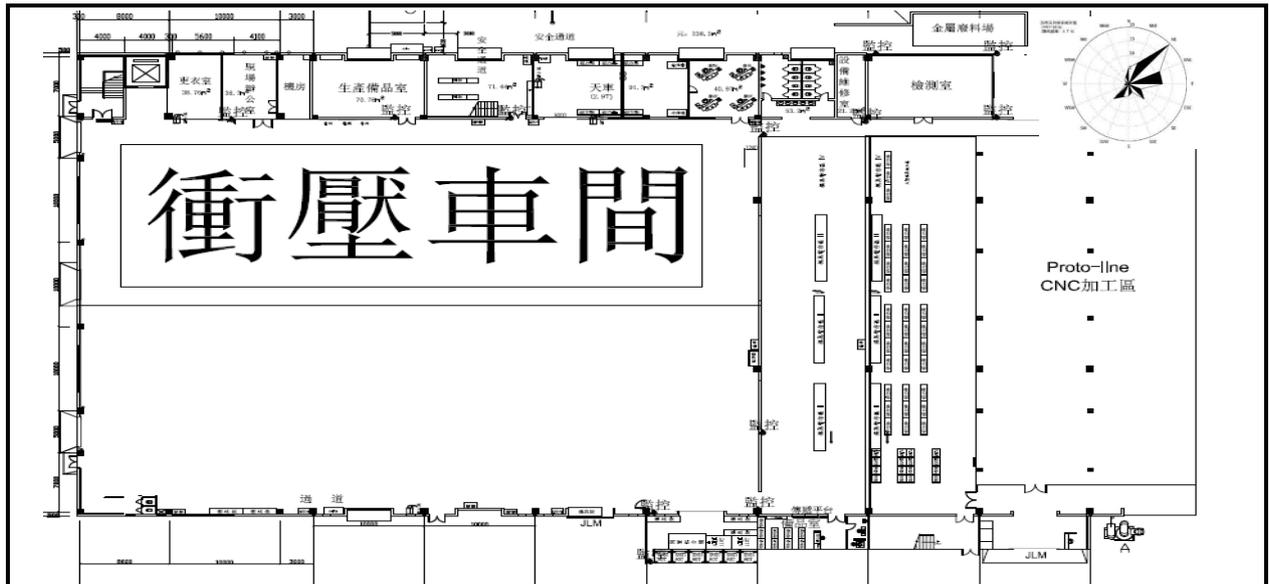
项目G4区厂房1栋1层C区车间平面布置图
